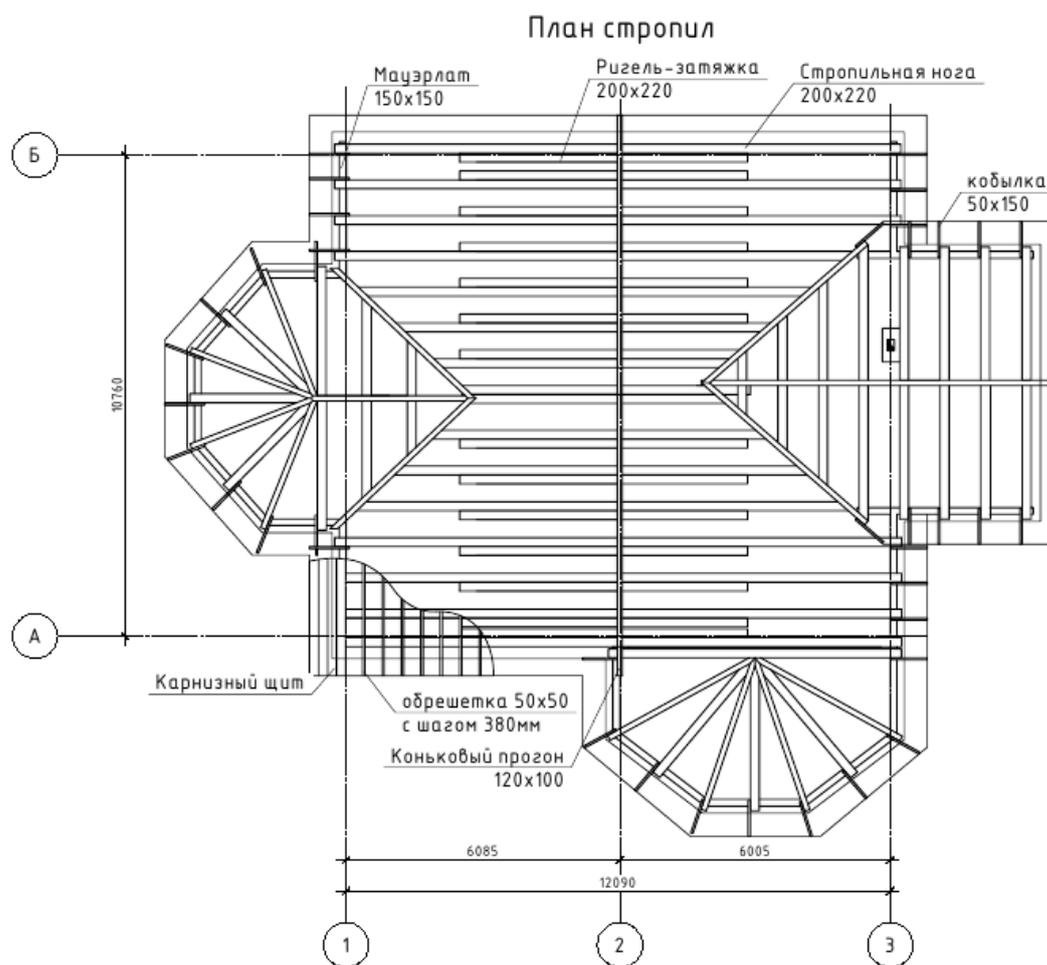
Пример оформления плана стропил малоэтажного жилого дома
